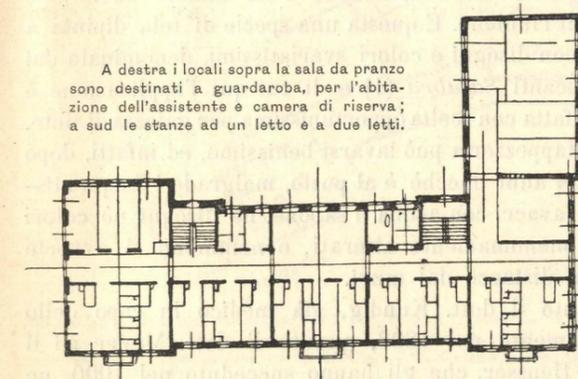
Pianta del secondo piano, eguale al primo piano (Scala di 1:700).
